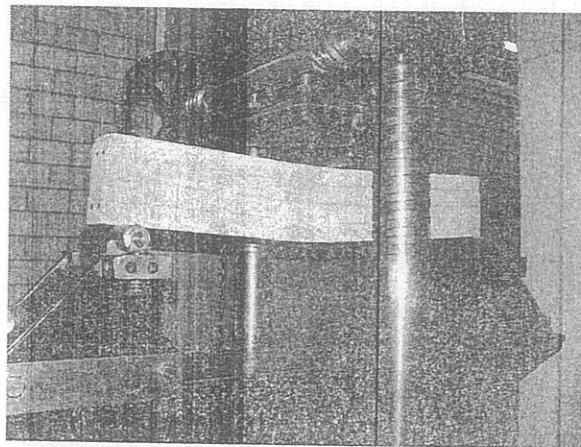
Essai de flexion 3 points d'une poutre en Béton Armé
